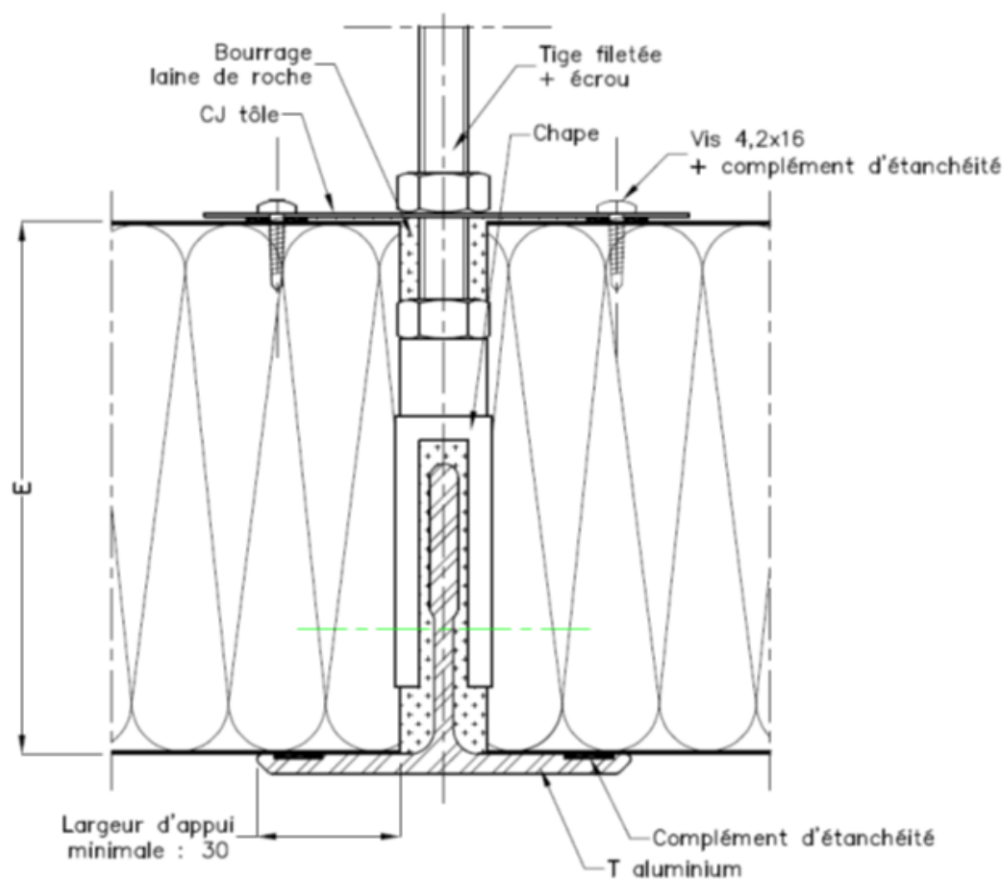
Schéma 1 – Panneaux reprise plafond – Reprise par T alu – la largeur minimale d'appui sur les ailes du Té est de 30mm.
